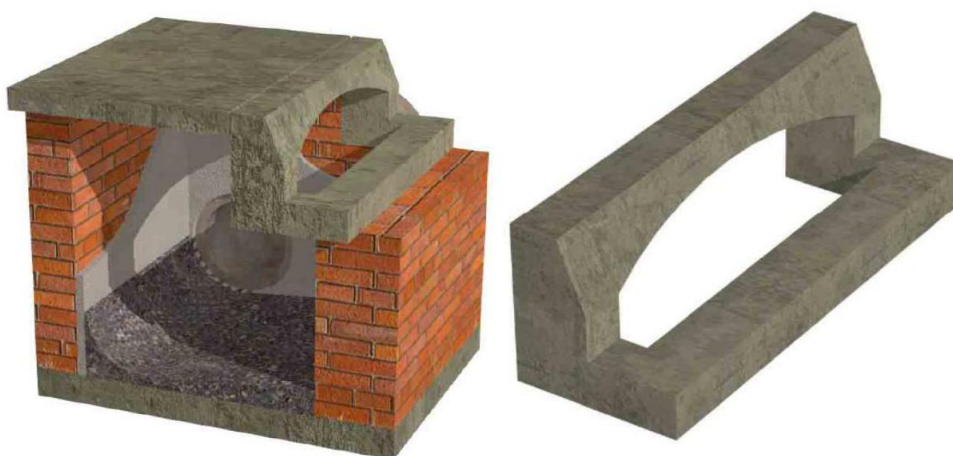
Boca-de-lobo em concreto armado e caixa de inspeção (fonte: Caderno de Encargos DEP-Porto Alegre/RS).
